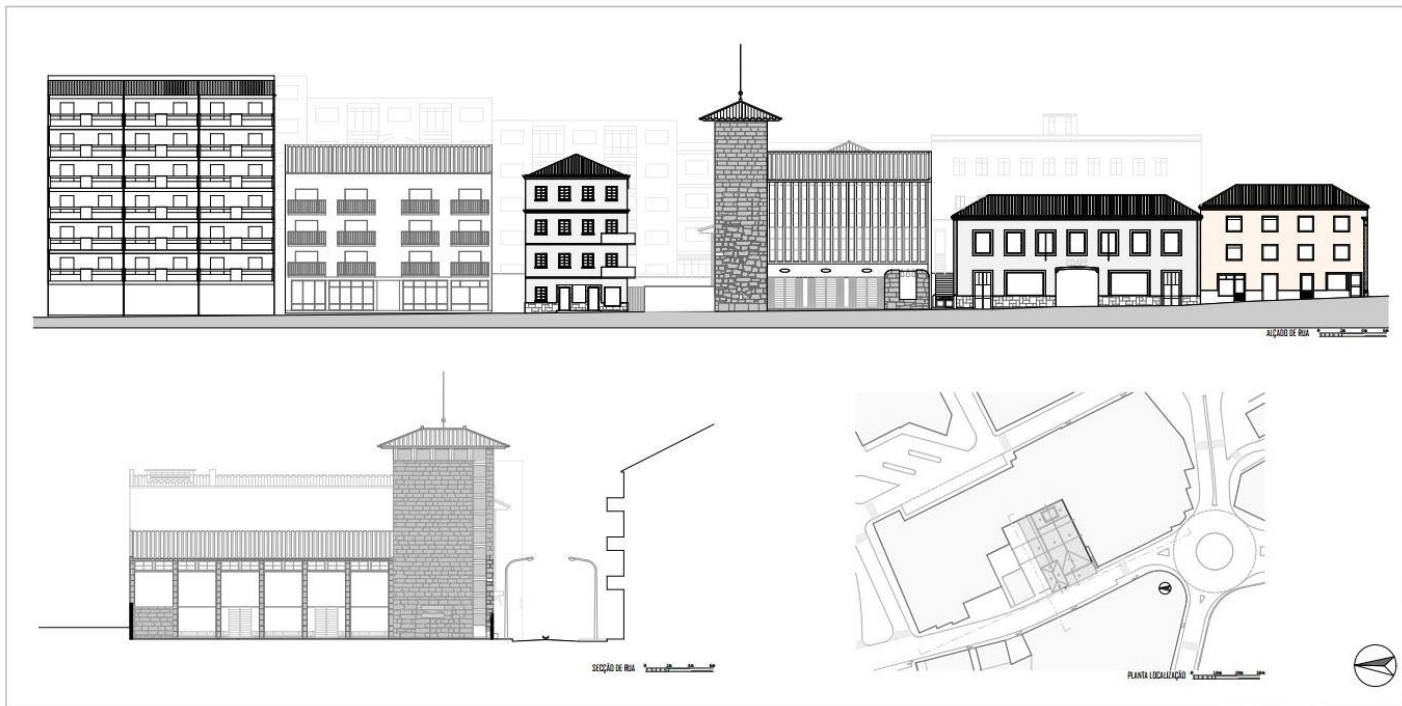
Cine-teatro Alçado de rua, Planta de localização e secção transversão da rua. Pedro Santos 2017
